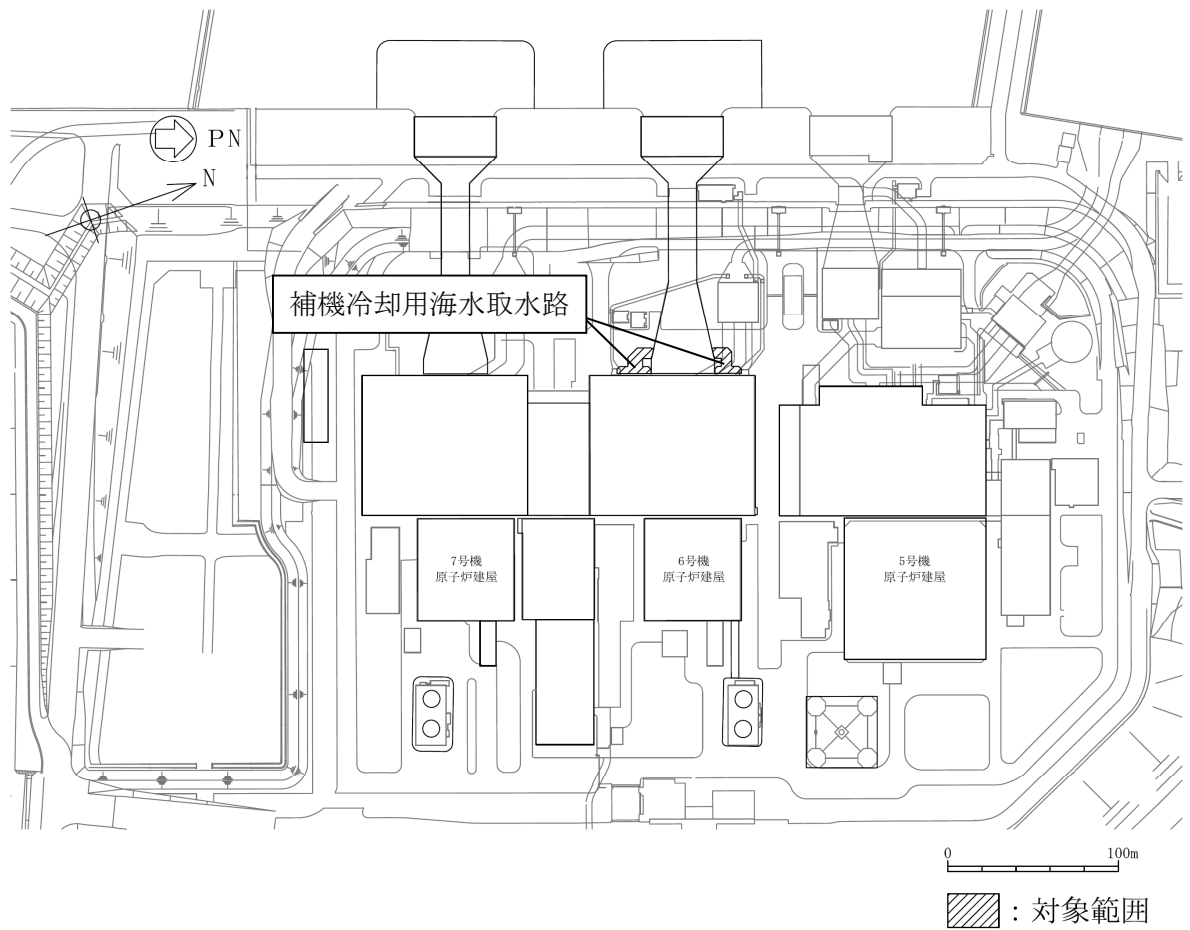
補機冷却用海水取水路の位置図（全体平面図）
